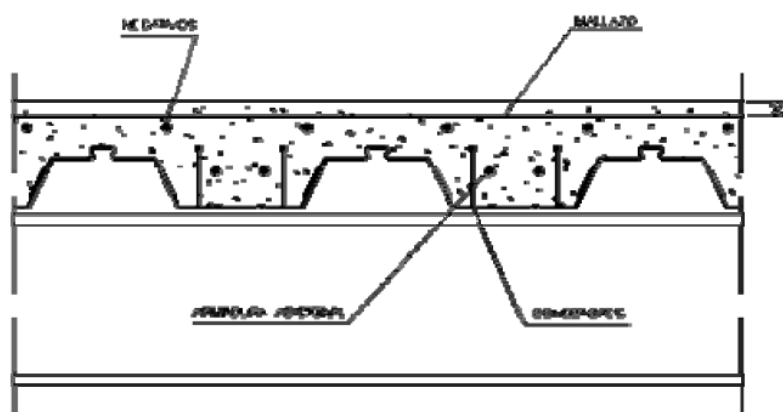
Ejemplo de colocación de los conectores sobre viga perpendicular a los nervios del perfil
